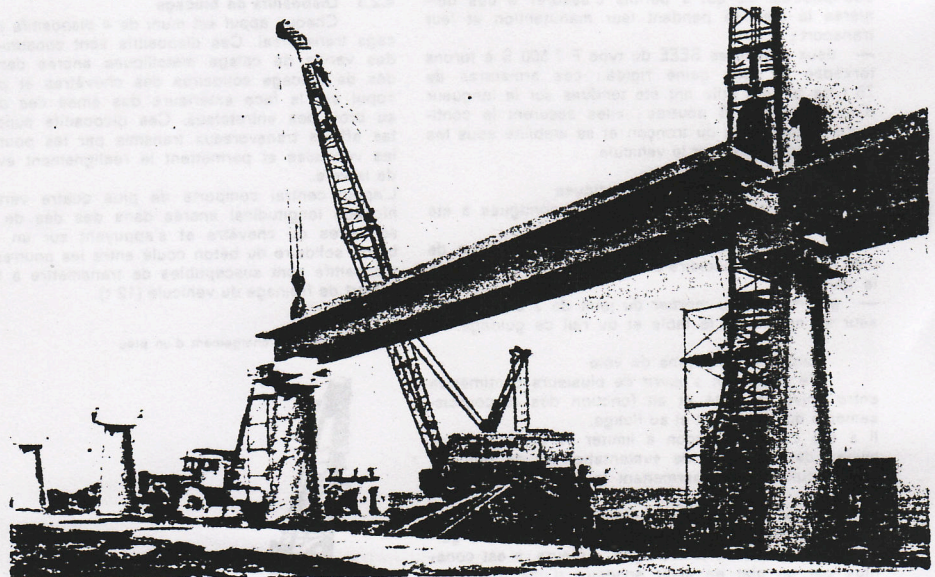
Lévage d'une poutre (Photo Baranger et Cie)
